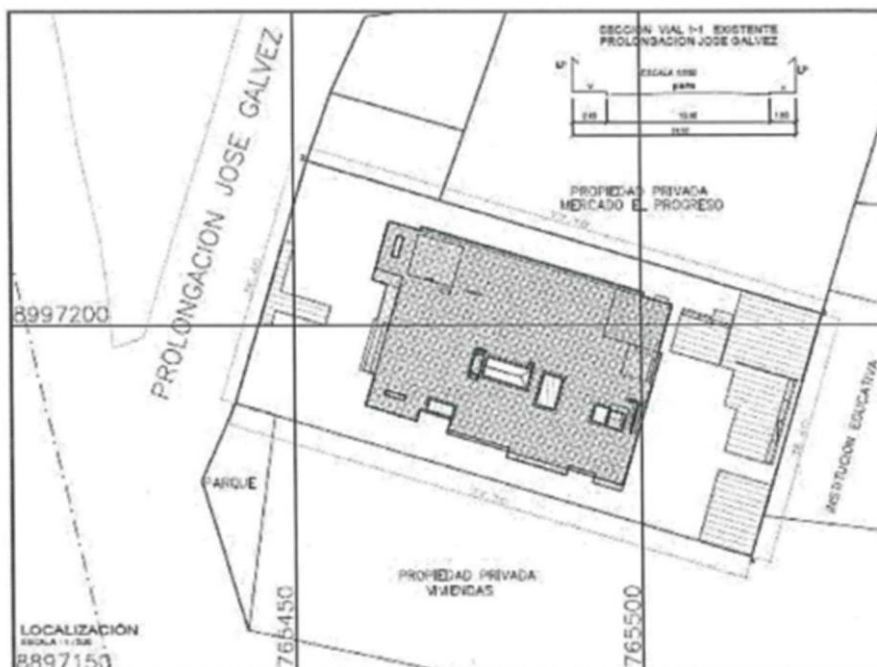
Plano de Ubicación en Planta del Proyecto
